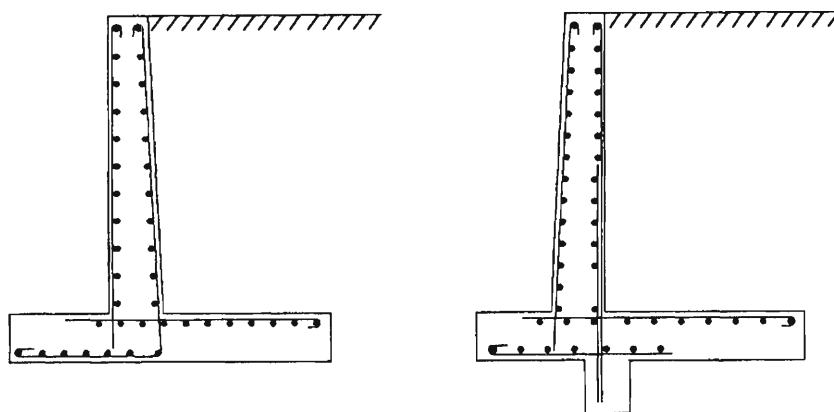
Criterios para el detallado del refuerzo en muros en voladizo
